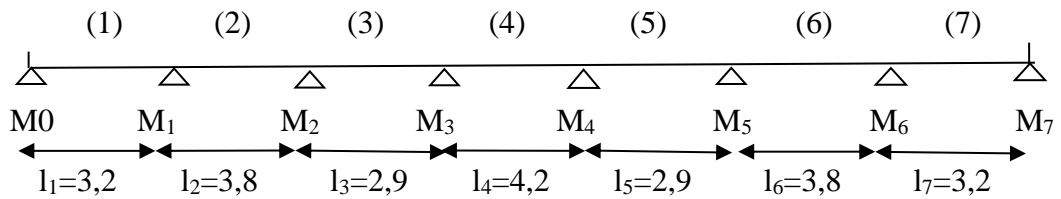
Schéma statique de la poutrelle à plusieurs travées.
